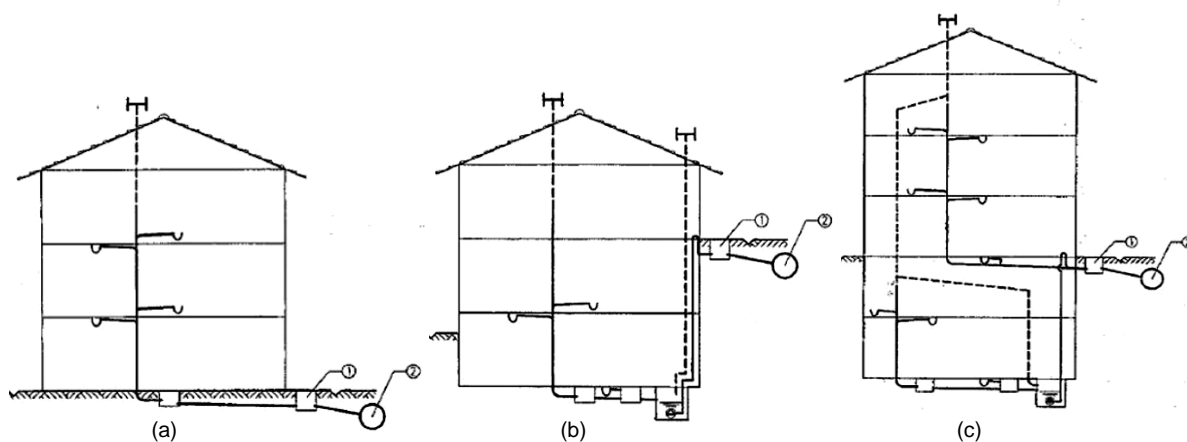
(a) Drenagem gravítica; (b) Drenagem com elevação; (c) Sistema misto (Pedroso V., 2000).
